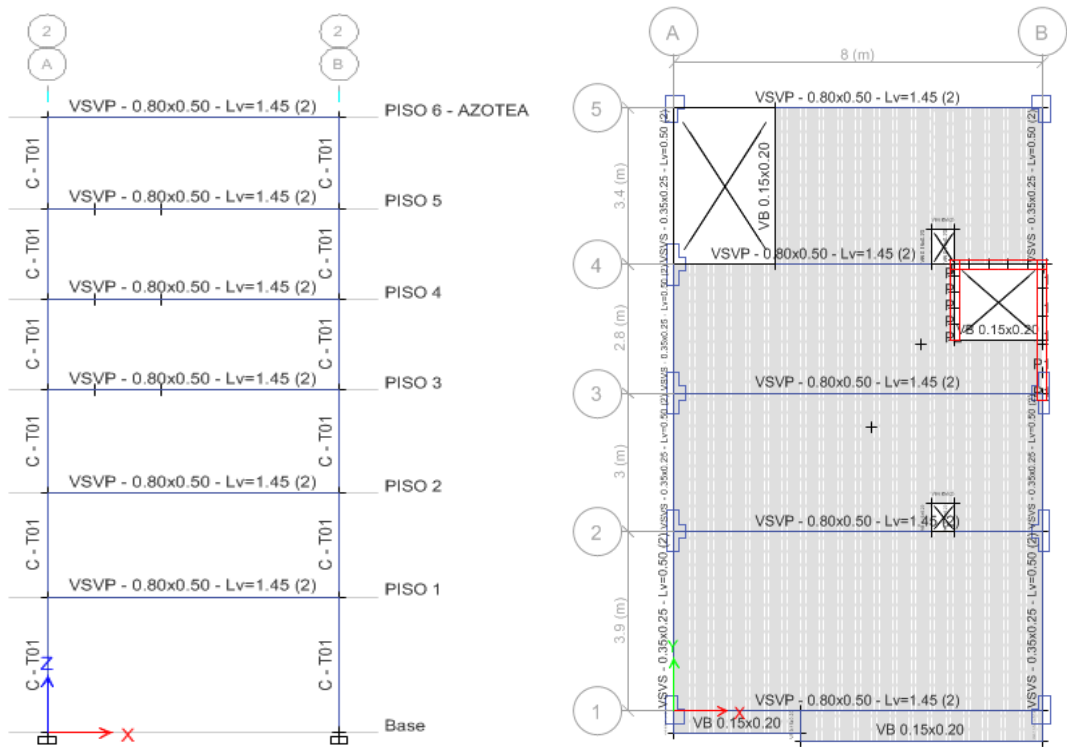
20 Vista en elevación y planta típica de la estructura del pórtico principal 2 - CASO N°02.
